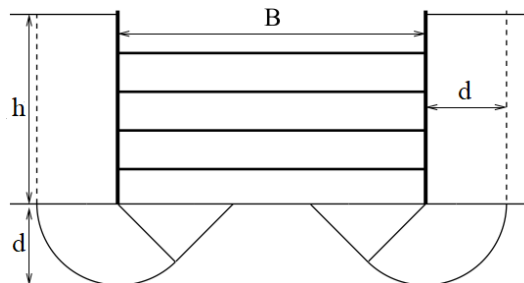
Rotura de fundo de escavação em escavações pouco profundas limitadas inferiormente por estrato rígido - adaptado de Guerra (2018).
